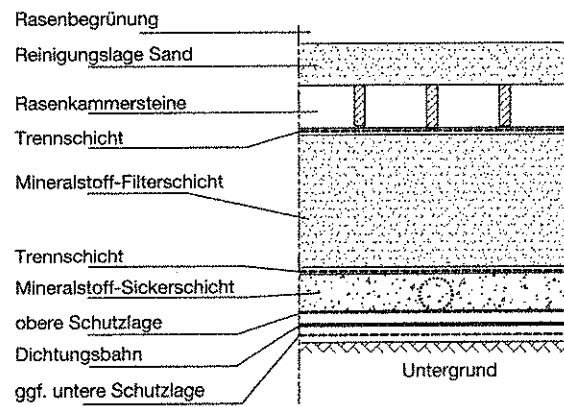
Aufbau eines Bodenfilterbeckens zur Reinigung von Oberflächenwasser mit einer Abdichtung zum anstehenden Boden hin (Rasenkammersteine schützen den Beckenaufbau und erleichtern das Befahren mit Wartungsgeräten)
